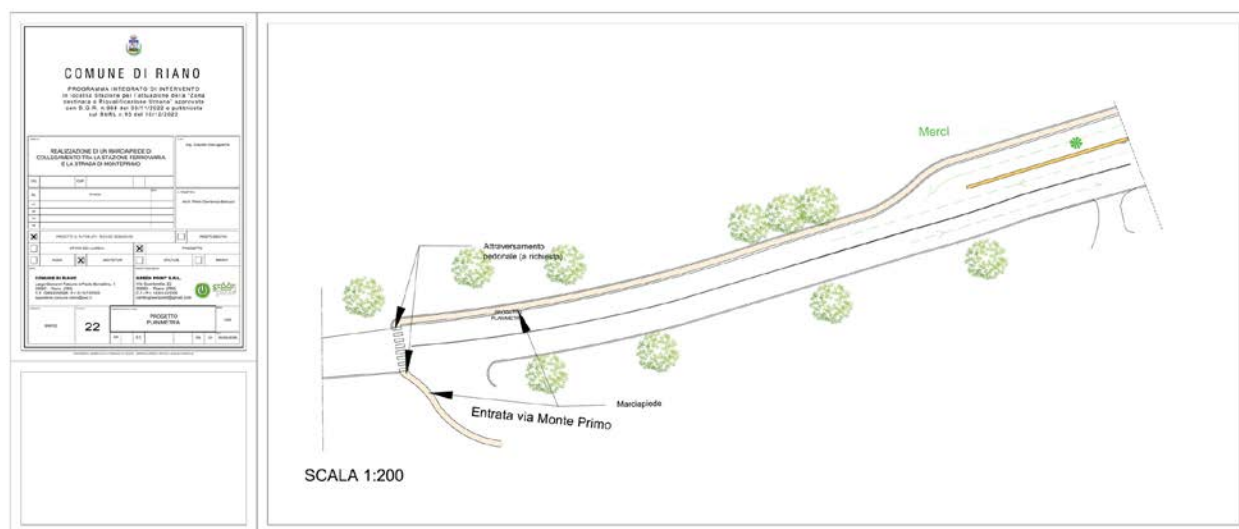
Tavola B22: planimetria di progetto con tracciato del marciapiede e attraversamento pedonale a richiesta.
